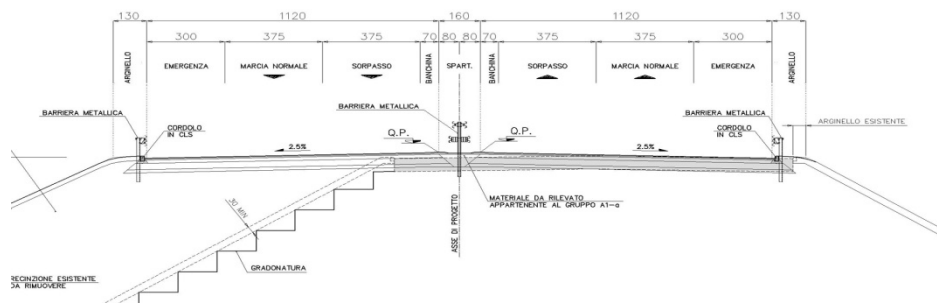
Sezione tipo di progetto (tratto di adeguamento SS1 Aurelia)
